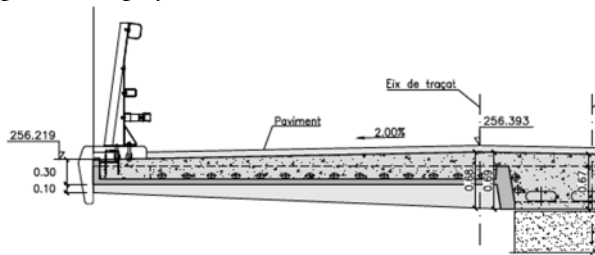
Sección transversal del tablero, incluida la prelosa que es de ancho completo.
